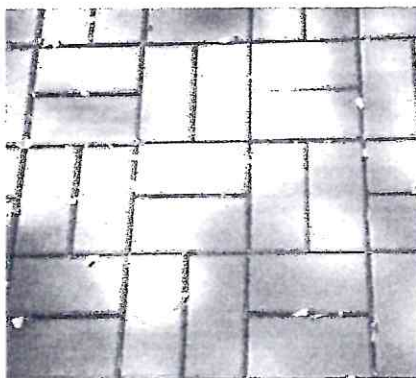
Piso intertravado assentamento tipo trama. Fonte: <https://lajestresmarias.com.br/project/paver-tradicional-pv09/>.
